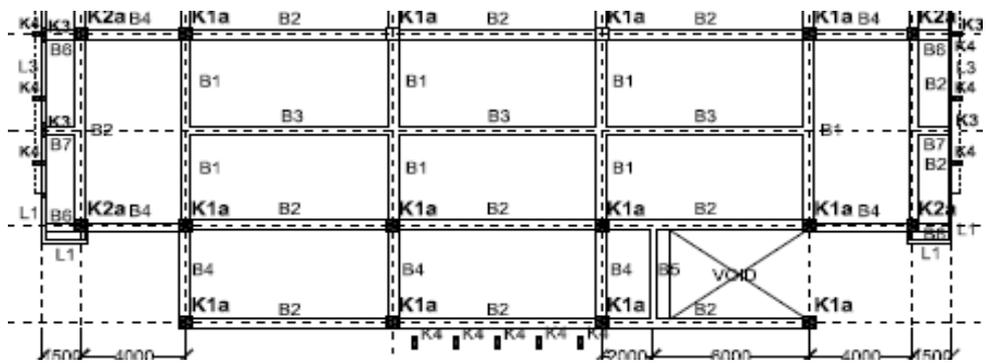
Denah Segmen 1 Pelat dan balok lantai 2 Gedung Kantor Tahap II KPPD di Kab.Sleman
